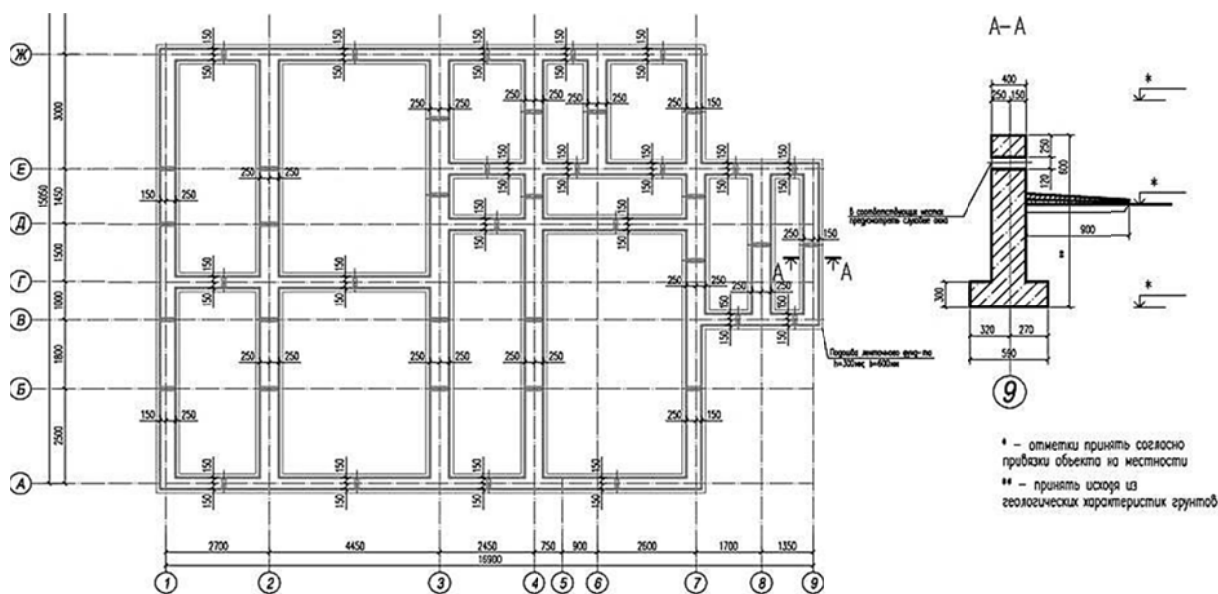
План и разрез ленточного монолитного железобетонного фундамента
